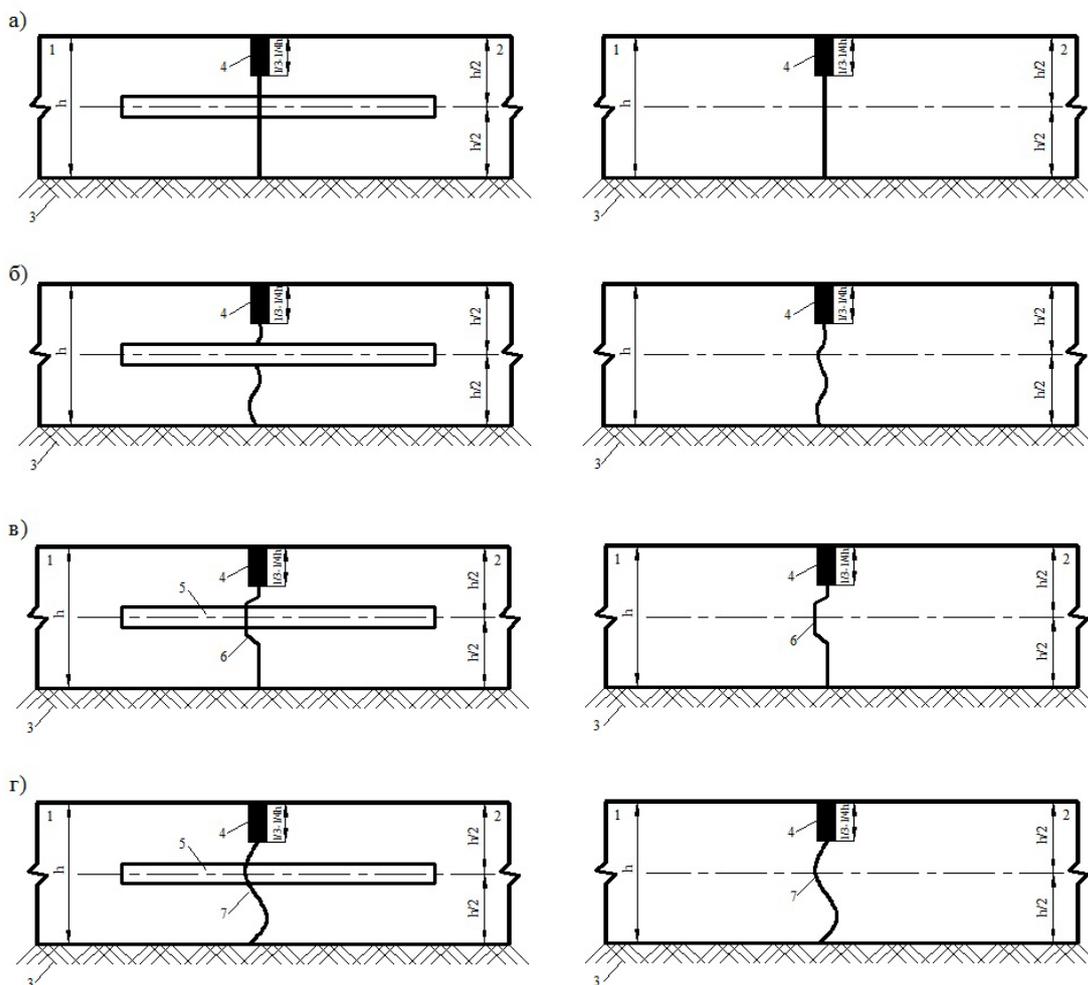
Схема расположения швов на цементобетонном покрытии
